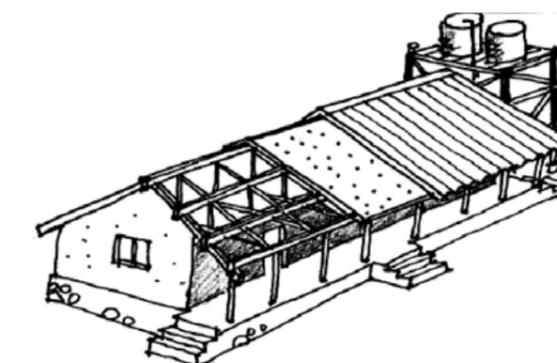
A, B Infraestruturas de educação. A construção de escolas elevadas protege contra as inundações. Telhados escolares reforçados protegem dos ciclones.
